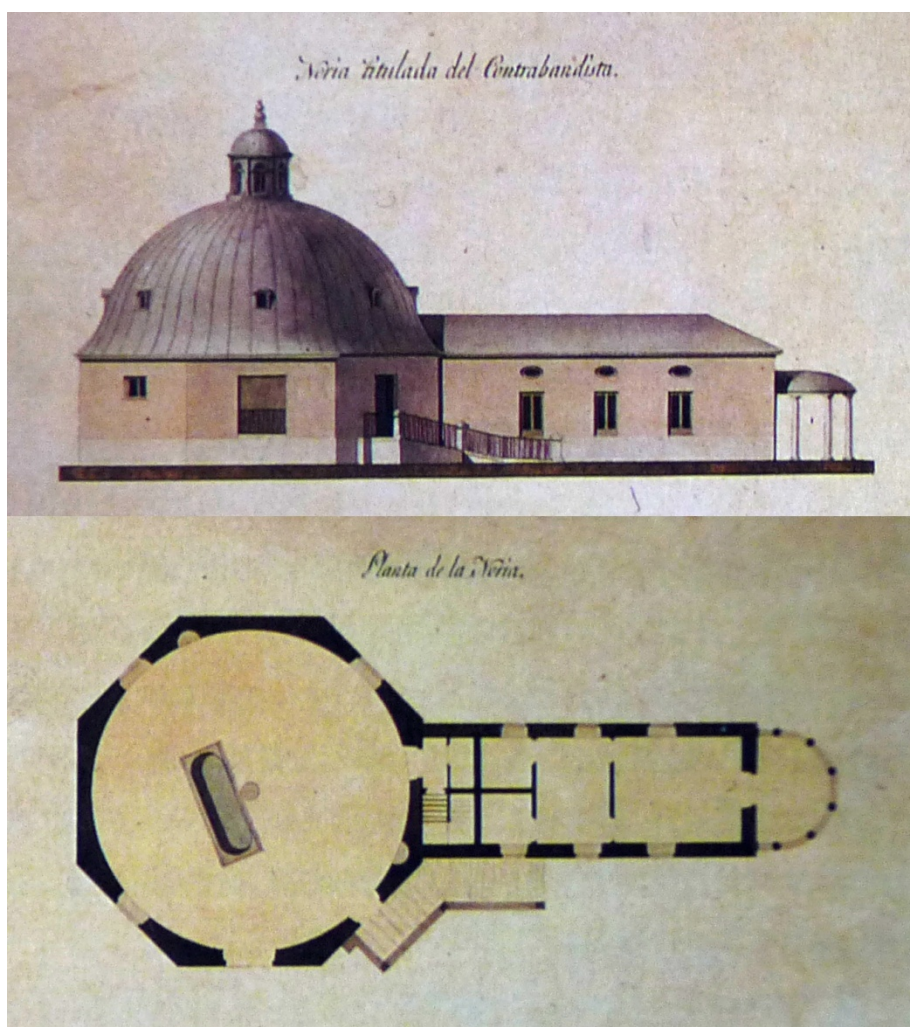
Detalle del plano anterior agrupando la planta y el alzado de la “Noria titulada del Contrabandista”.
